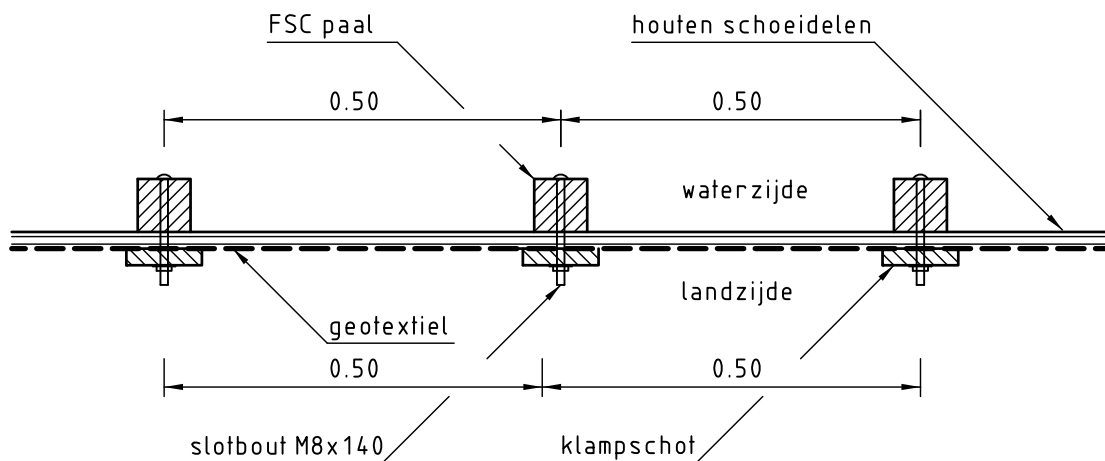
DETAIL BESCHOEIING HOOFDWATERGANG GRENZEND AAN OPENBAAR GEBIED
